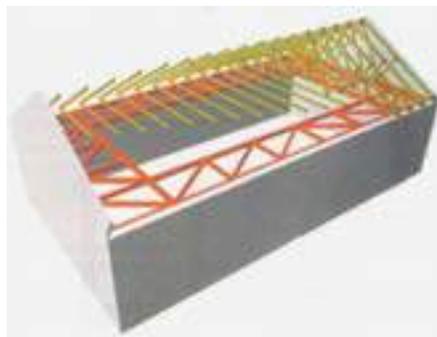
Diaphragme dans le plan des entrants, formé par des poutres au vent en treillis (source AFPS)
